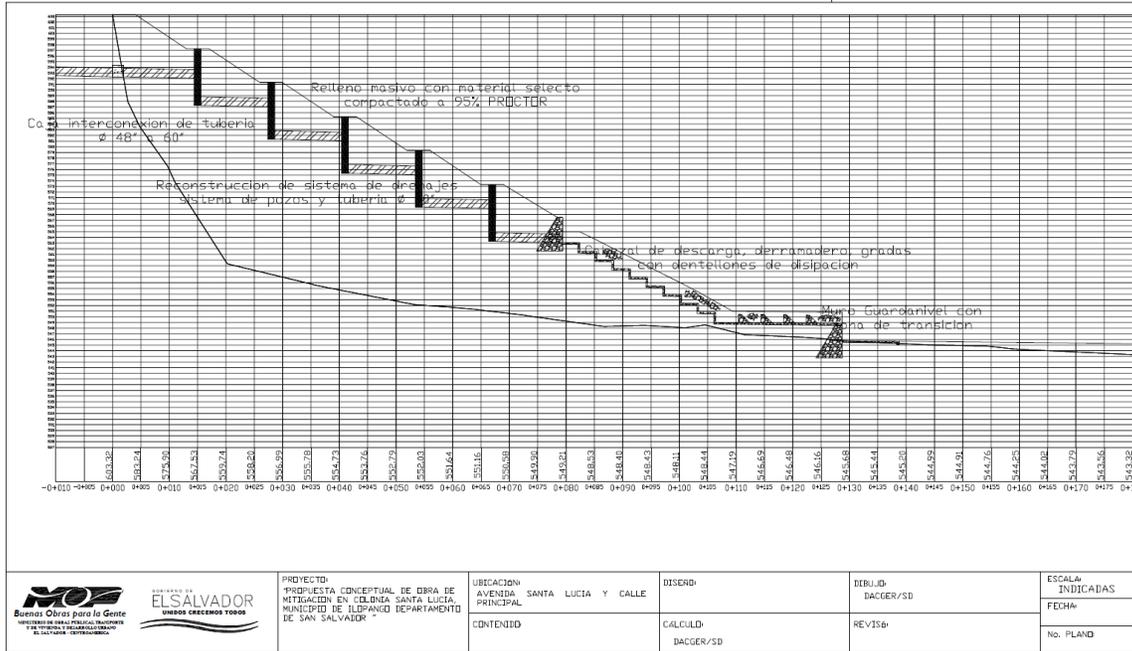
Esquema de obra propuesta, Vista de Perfil.
